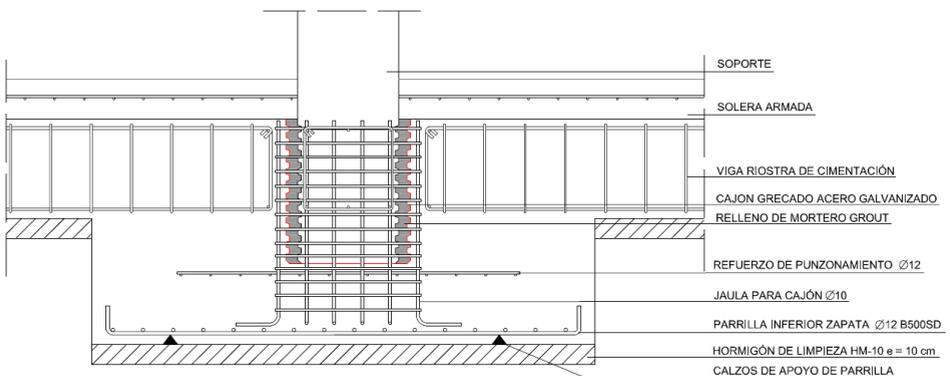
Cimentación por cáliz. 2015. Fuente: Propia
